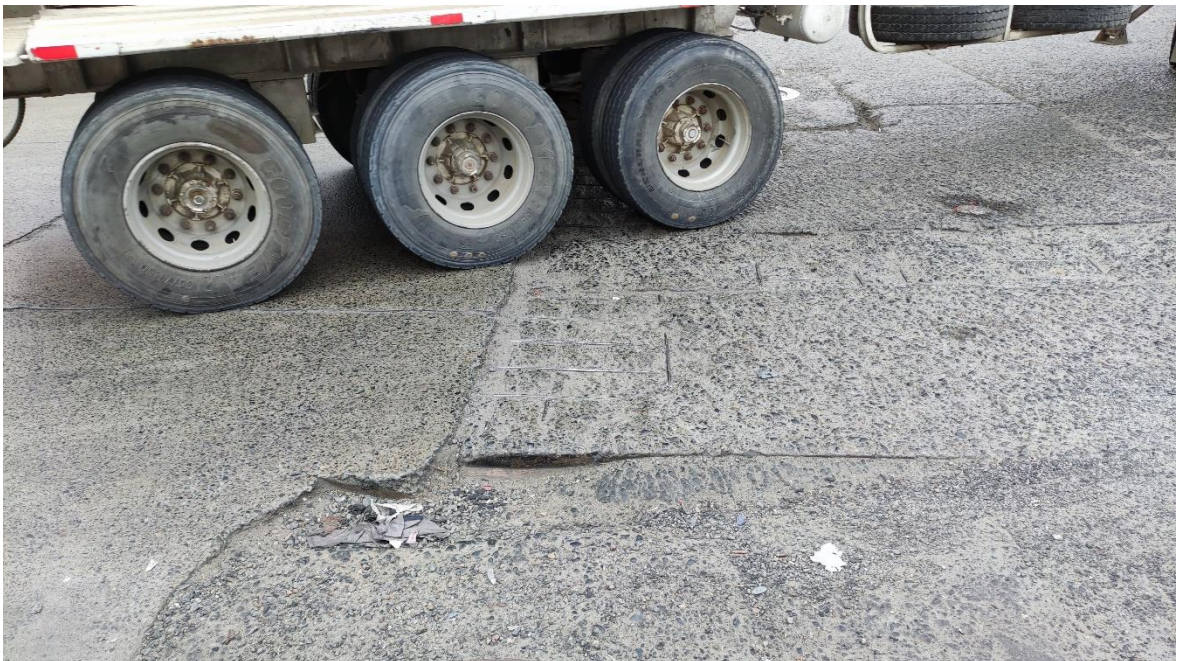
Situación Actual del Pavimento Rígido en la Av. Aviación Cuadra 3
